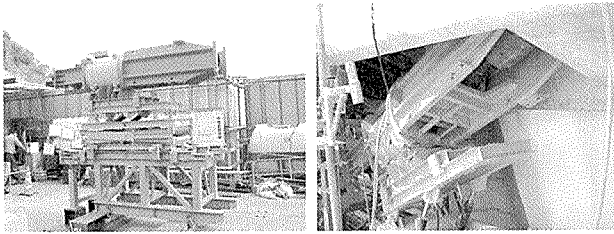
ジャッキリフター試験 写真-13 斜材緊張状況
